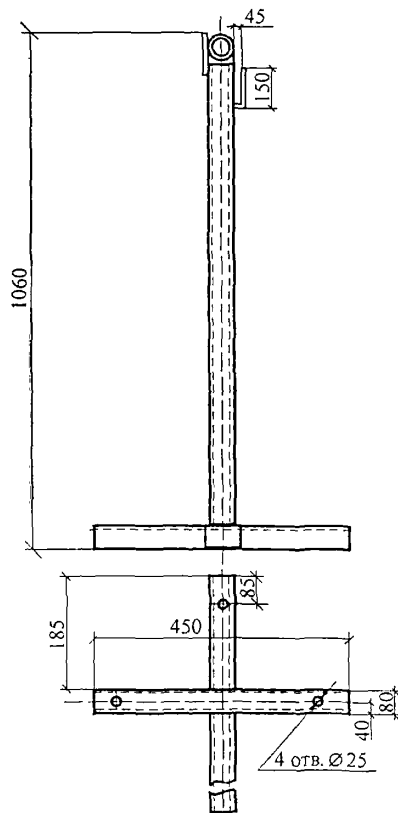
Схема установки сигнального ограждения опасной зоны у стены
